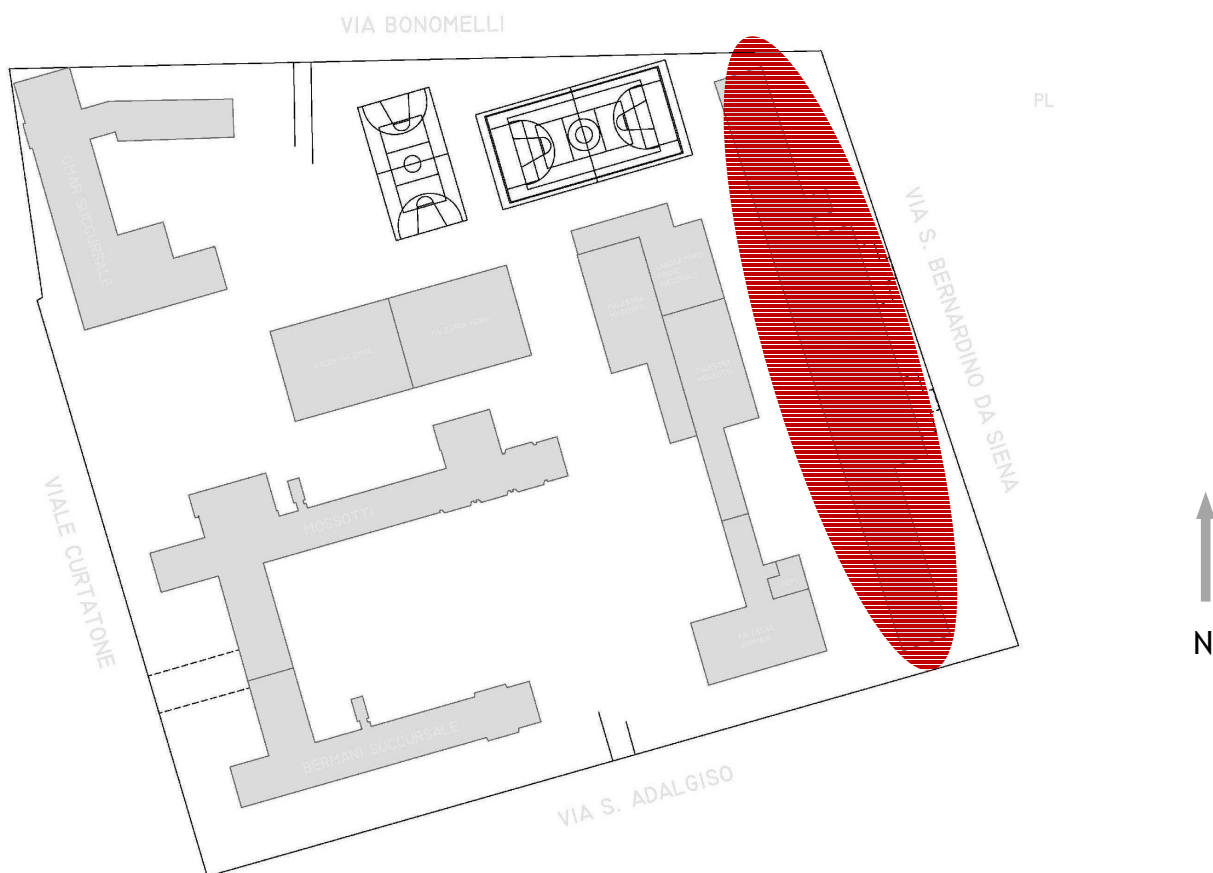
Planimetria generale Complesso scolastico Nervi - Mossotti - Bermani
